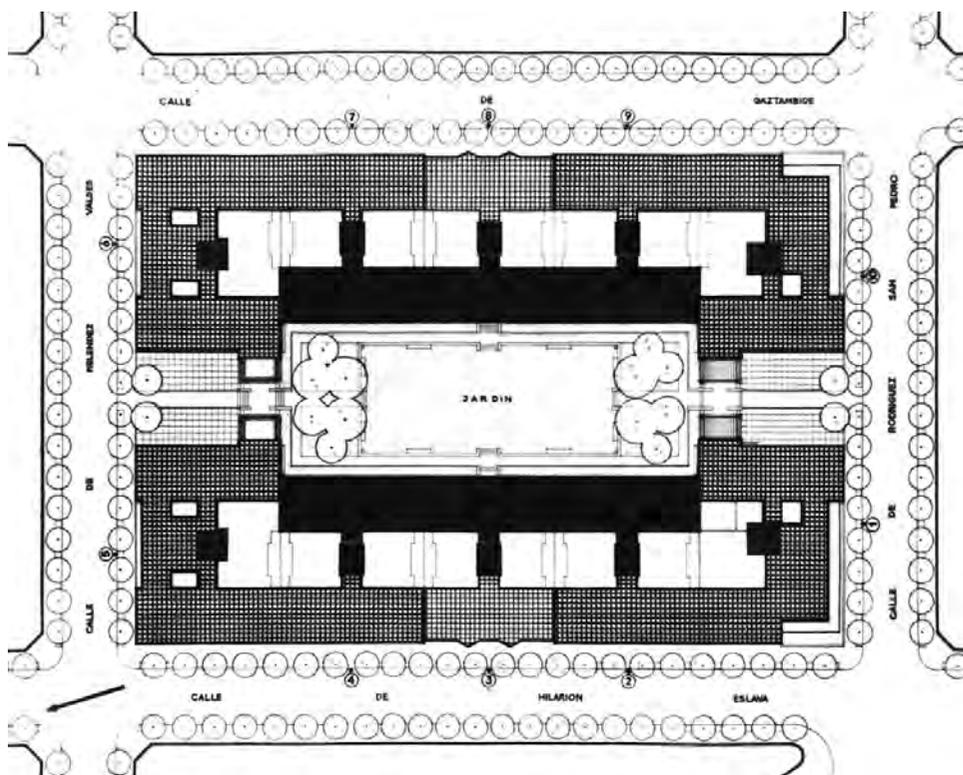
Planta General de la Casa de las Flores, Madrid, 1931
